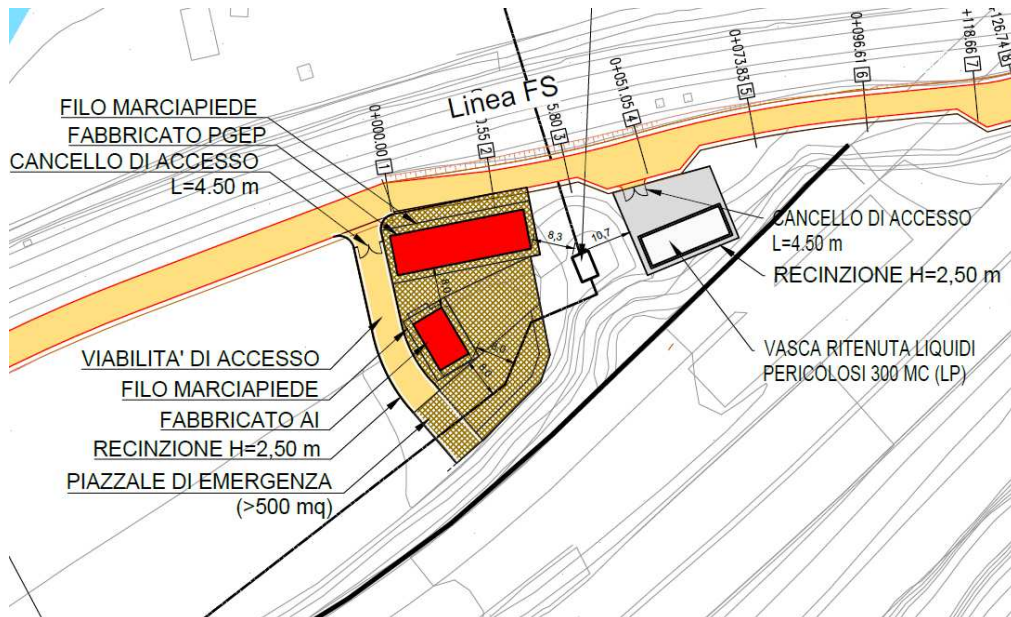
Pianta piazzale di emergenza della finestra di Funes
